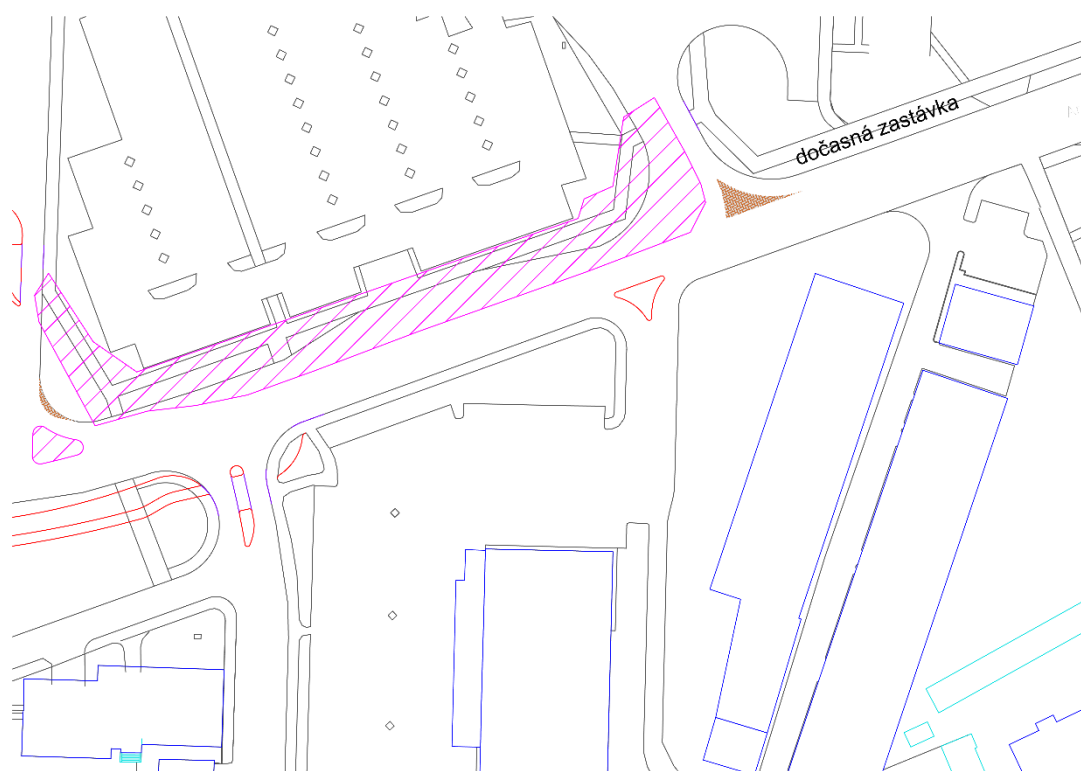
varianta 2 po fázi 1,2 výstavby
